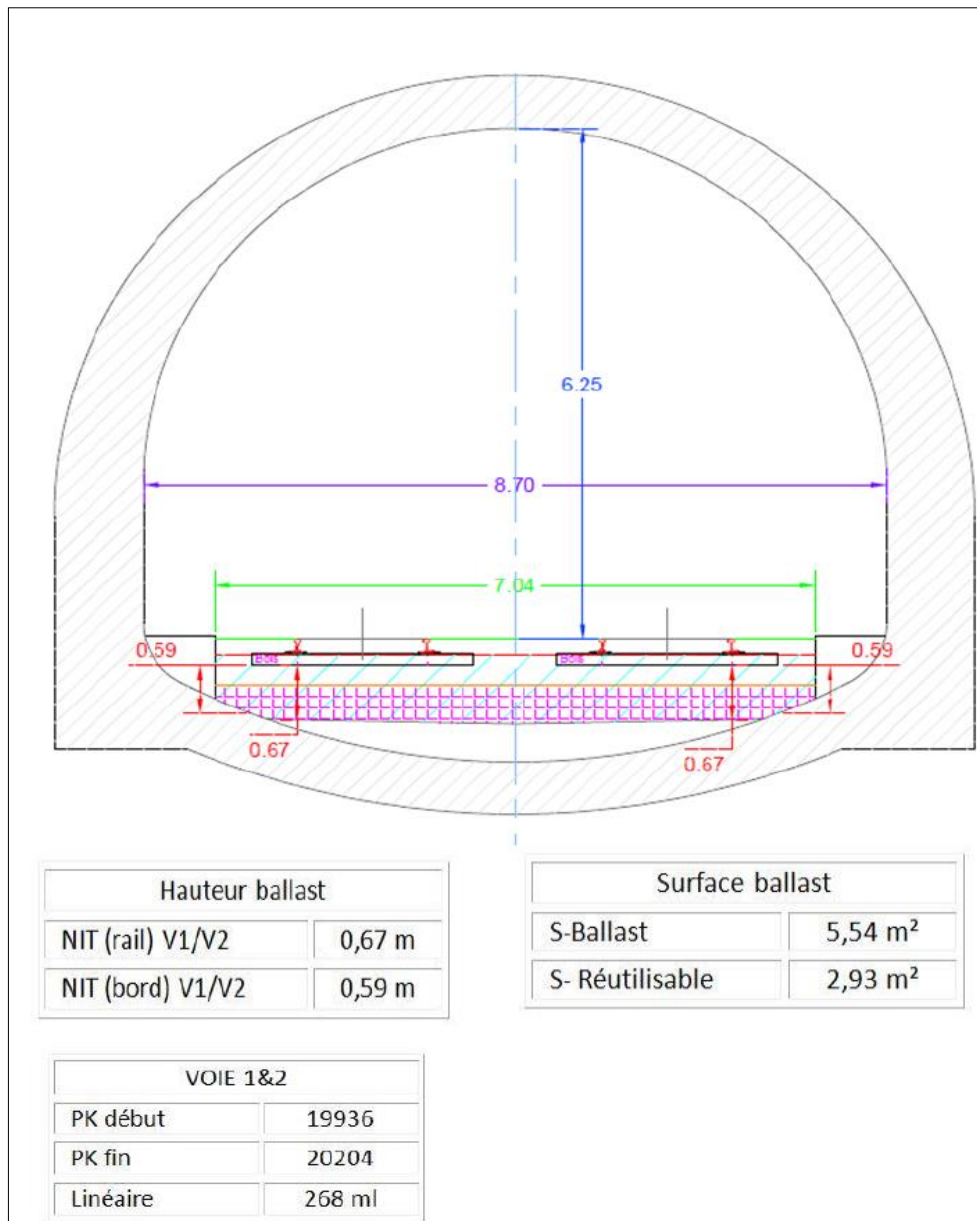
Coupe schématique de tunnel et calcul des sections de ballast
